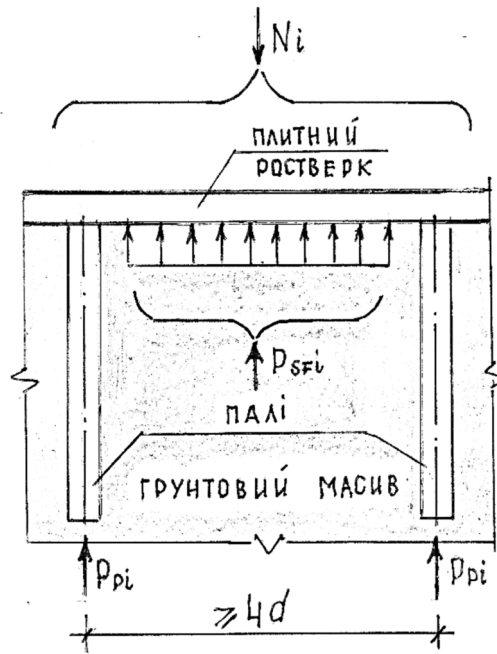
Схема роботи плитно-пального фундаменту [5]
